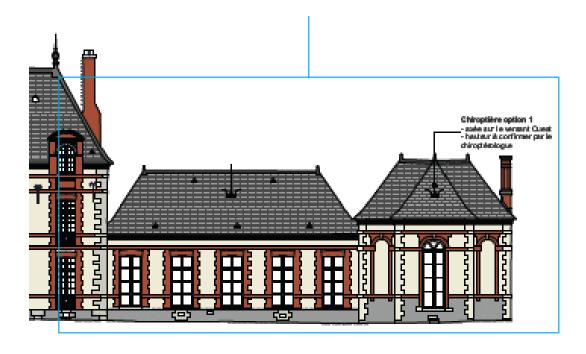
Localisation de la chiroptière installée sur la toiture du comble au-dessus du salon tréflé – Vue extérieure de la façade ouest du château
